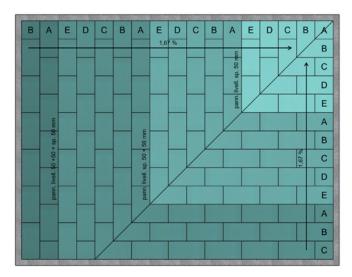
Drenaggio verso l'angolo del parapetto laterale
